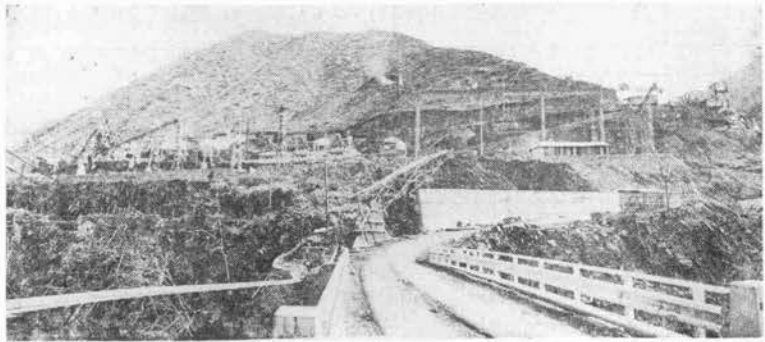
下牧骨材プラント(前面の山の背部が原石山)
